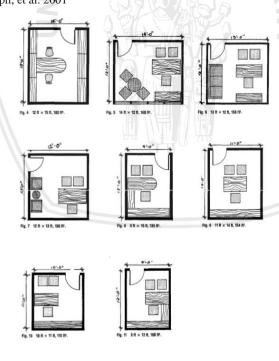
Contoh layout ruang kerja privat sumber : De Chiara, Joseph, et al. 2001
